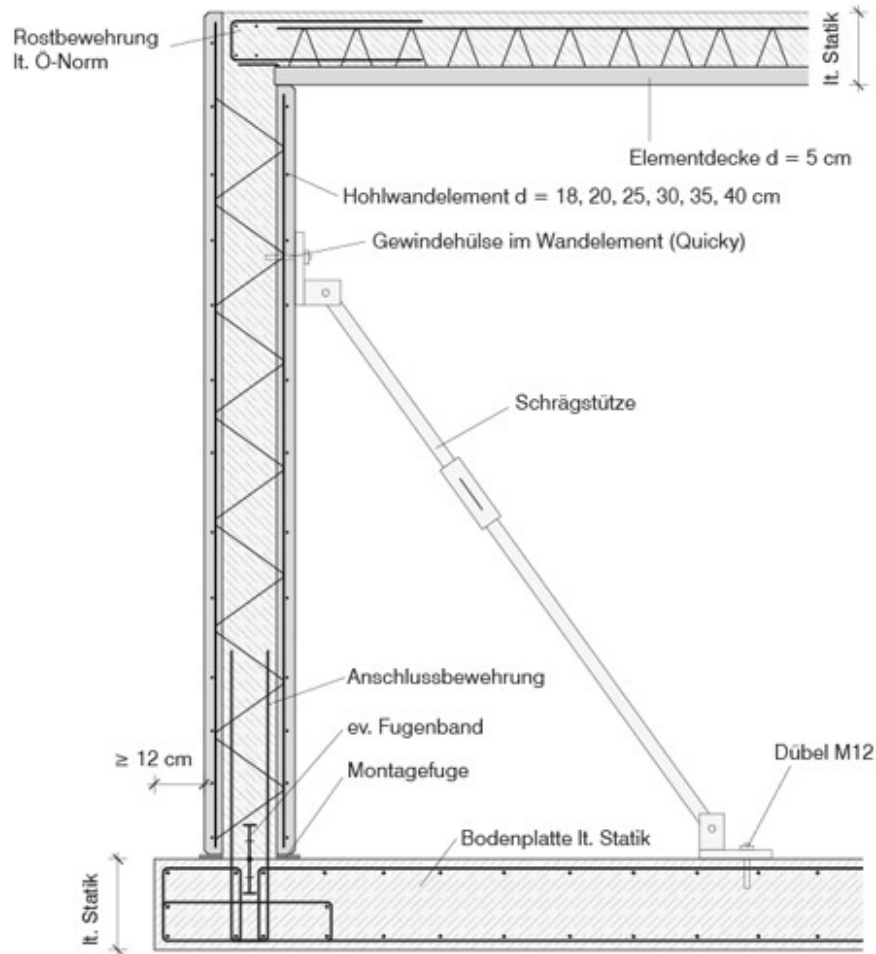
Knoten Fundament / Hohlwand / Elementdecke<sup>62</sup>
